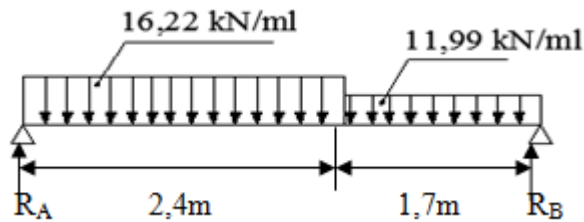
schéma statique de chargement d'un escalier droit à l'ELU
